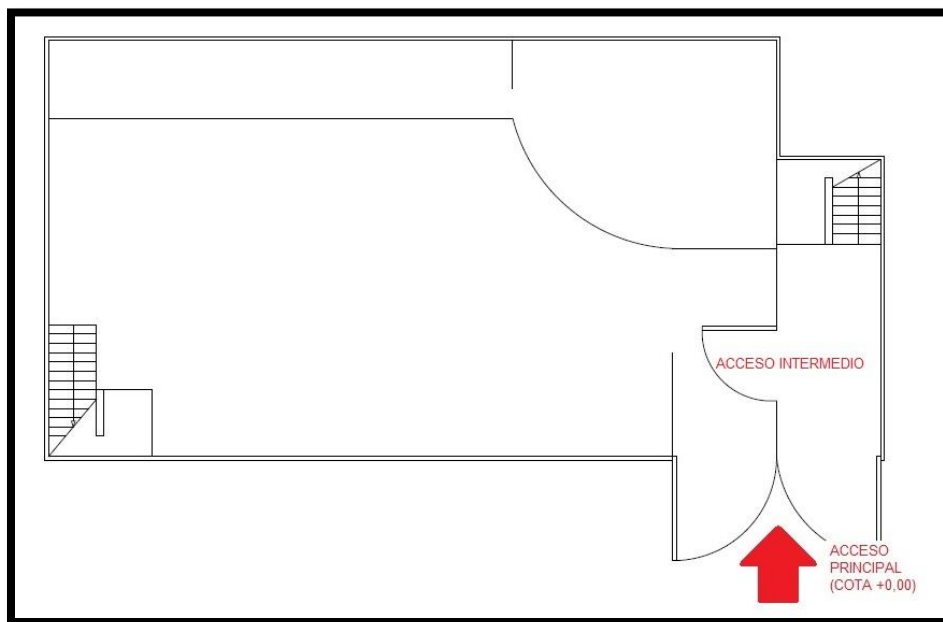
“Vista en planta de accesos y escaleras del piso principal (cota +0.00) de la discoteca 2.”
